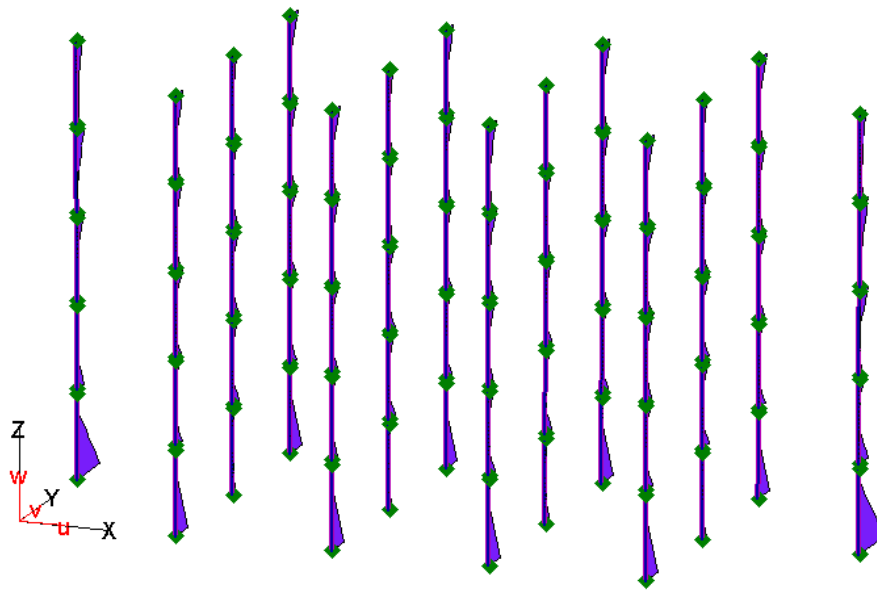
Эпюры арматуры в колоннах, кроме угловых (Схема с использованием стержневых элементов по нормам Еврокода).
